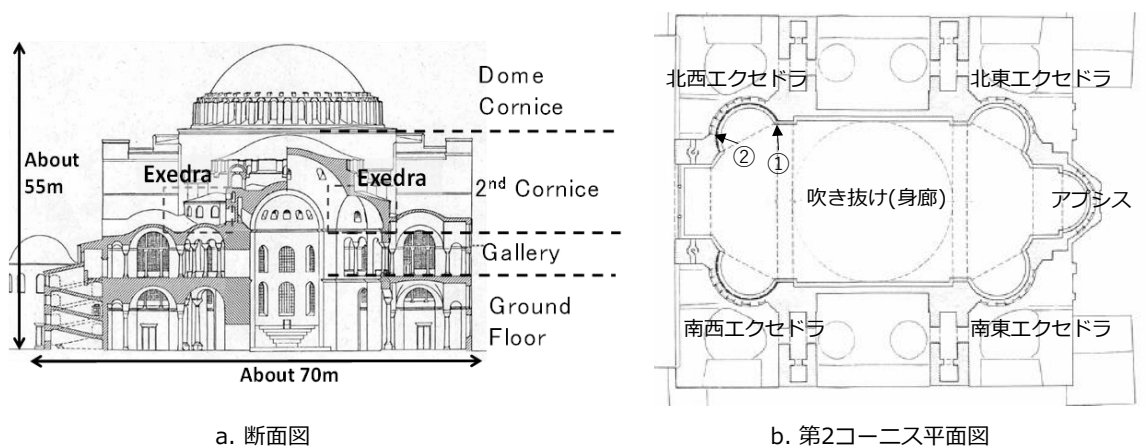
ハギア・ソフィア大聖堂の(a)断面図と(b)第2コーニスの平面図^[3-1]
